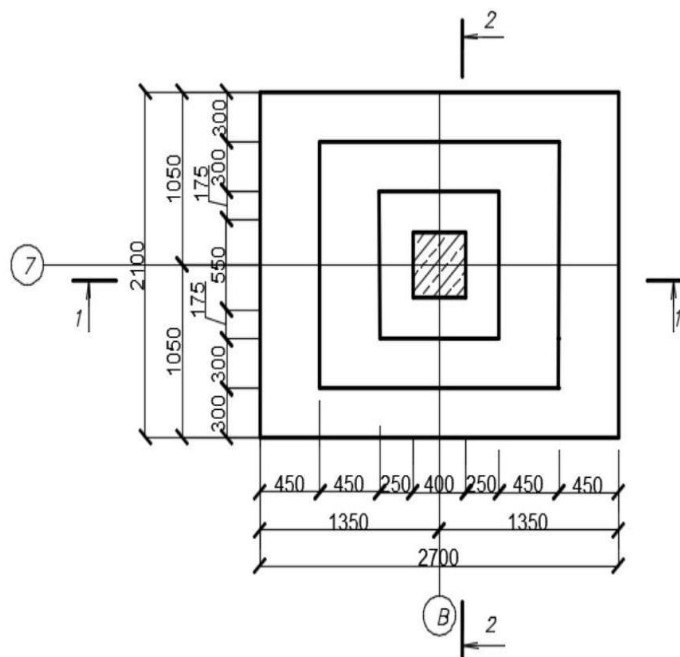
Схема розрахунку арматури плитної частини фундаменту
